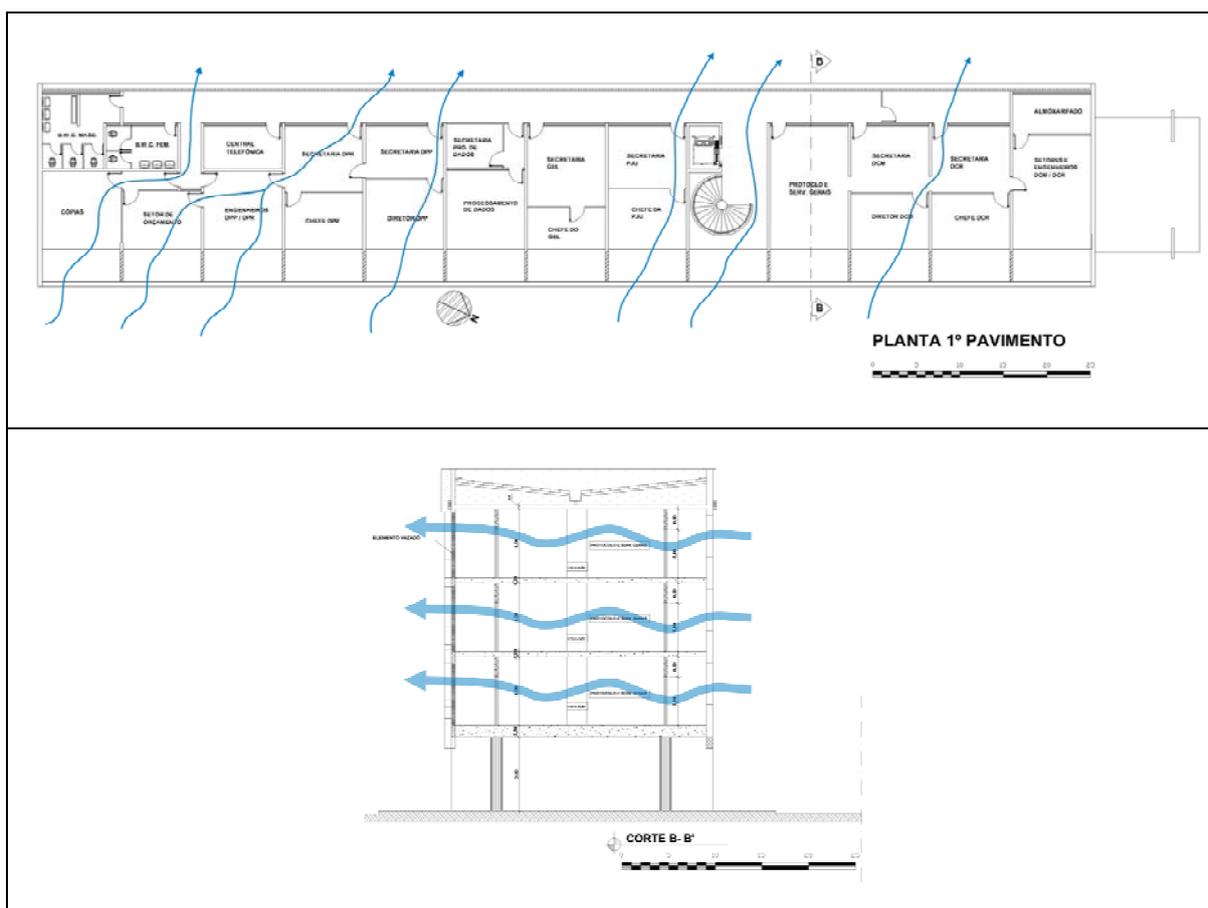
Edifício DER – estudo da ventilação cruzada na planta baixa e corte
